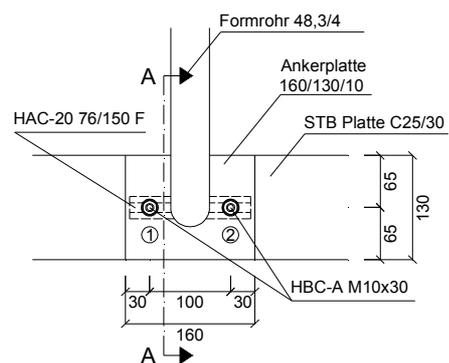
Anschlussdetail G1 Ankerschiene (Maße in mm)
